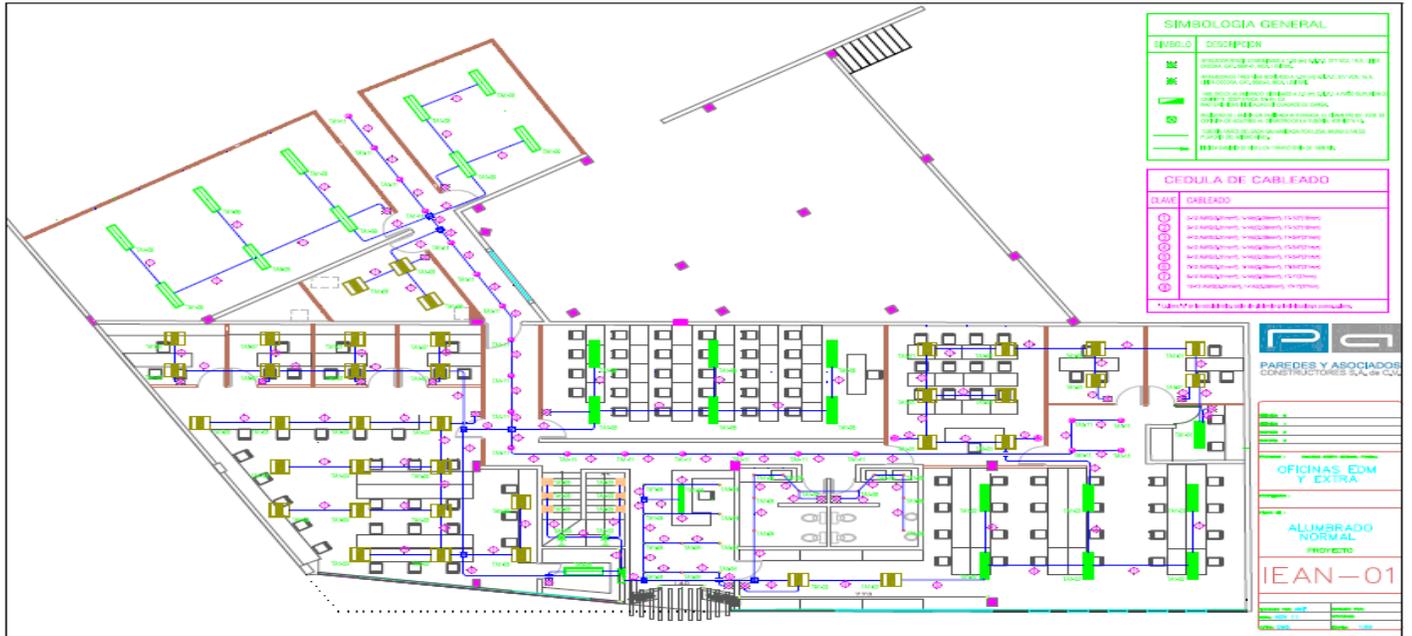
PLANO DE ALUMBRADO EN PLANTA BAJA; DONDE SE MUESTRA LA UBICACIÓN DE LAS LUMINARIAS.
